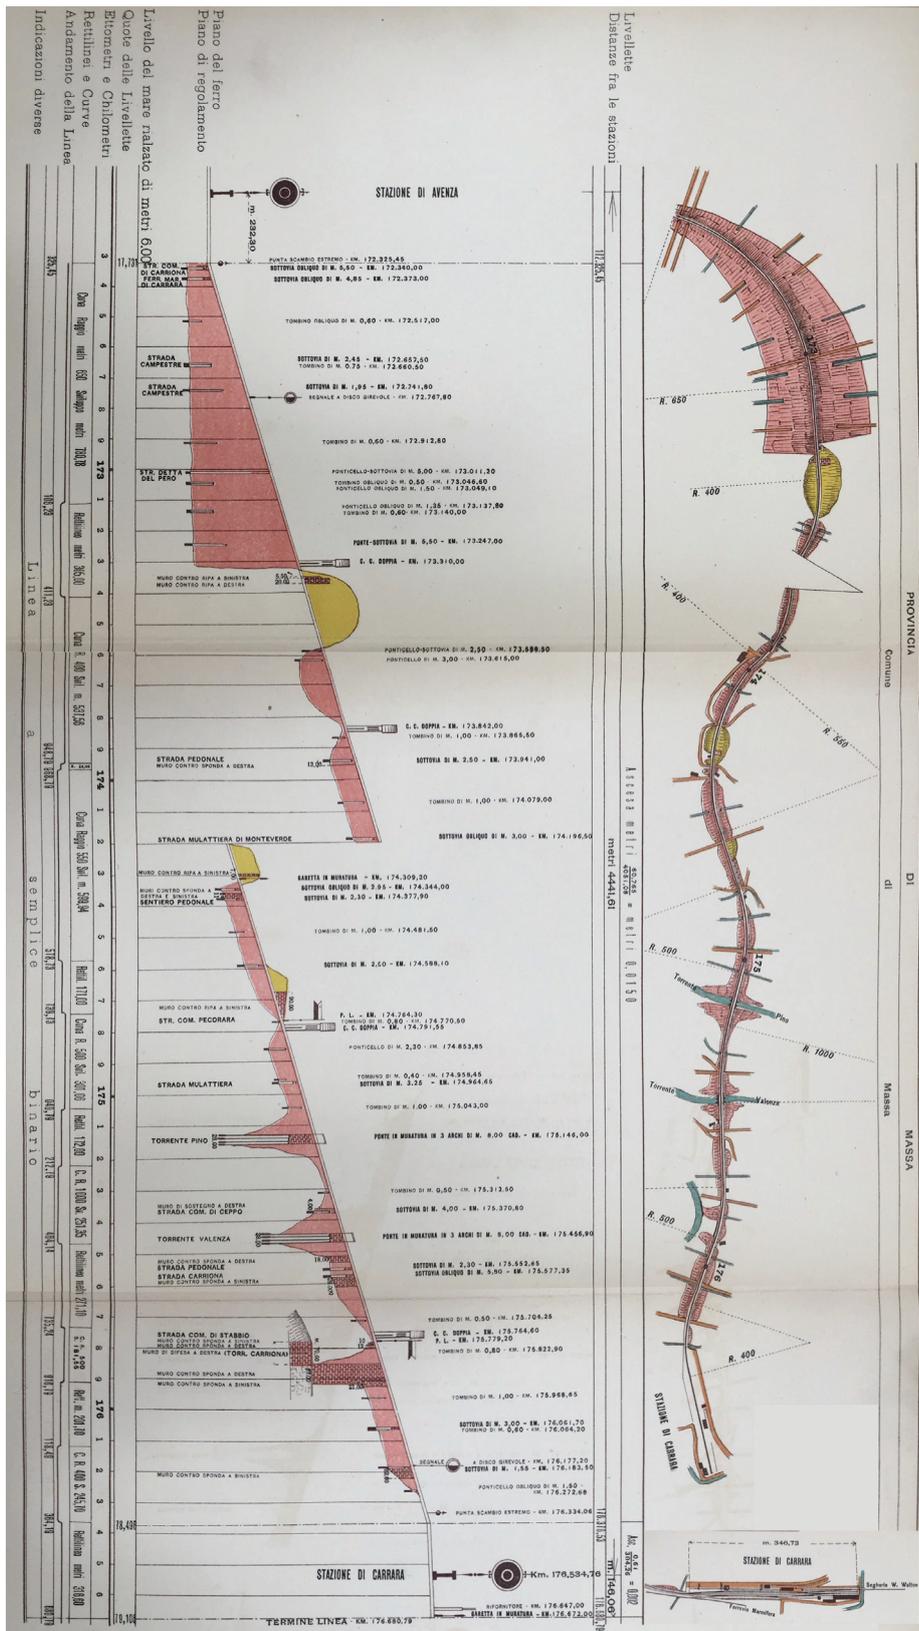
Linea Avenza-Carrara di lunghezza m. 4.355,74: planimetria
